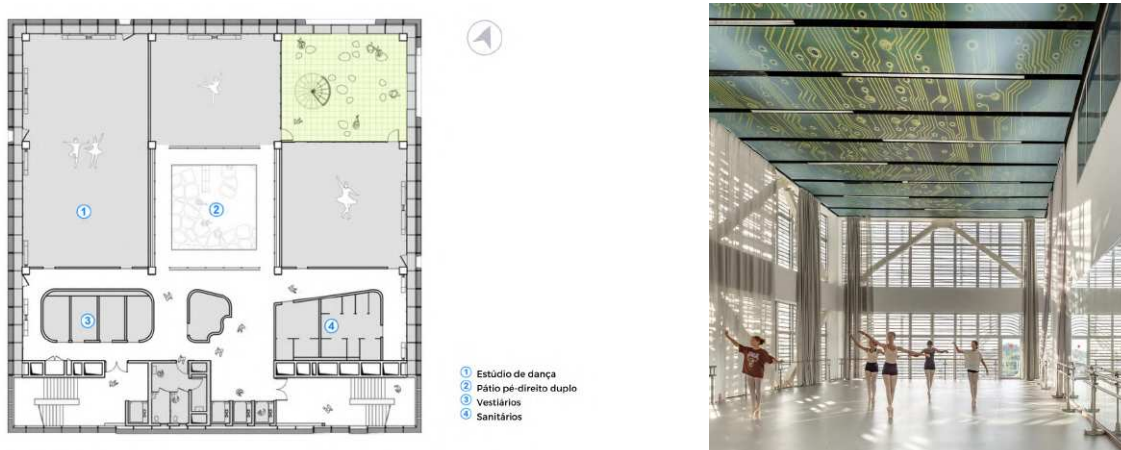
Planta 1º pavimento Escola Regional de Música e Dança
